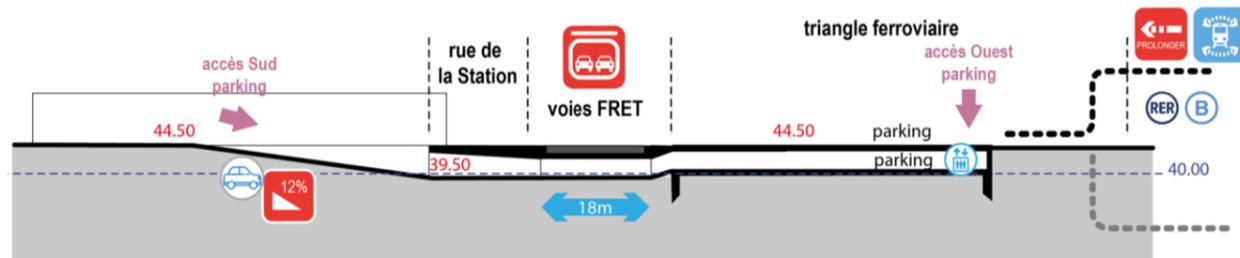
Coupe de principe rue des Cheminots : entrée Sud du parking (Drancy) (source : Egis)
